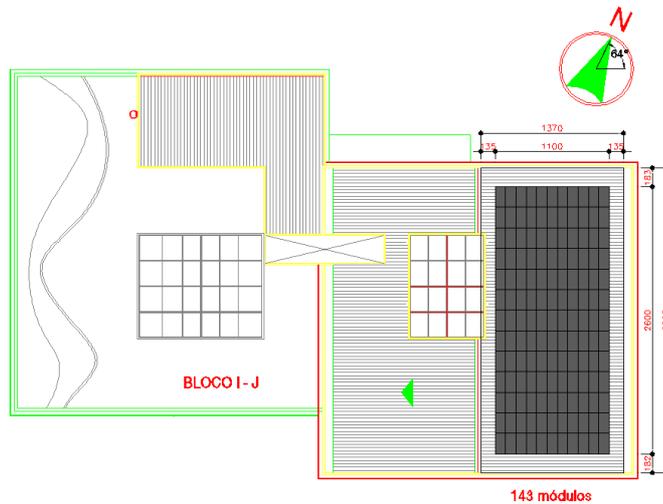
Planta da cobertura do bloco I-J com módulos.
